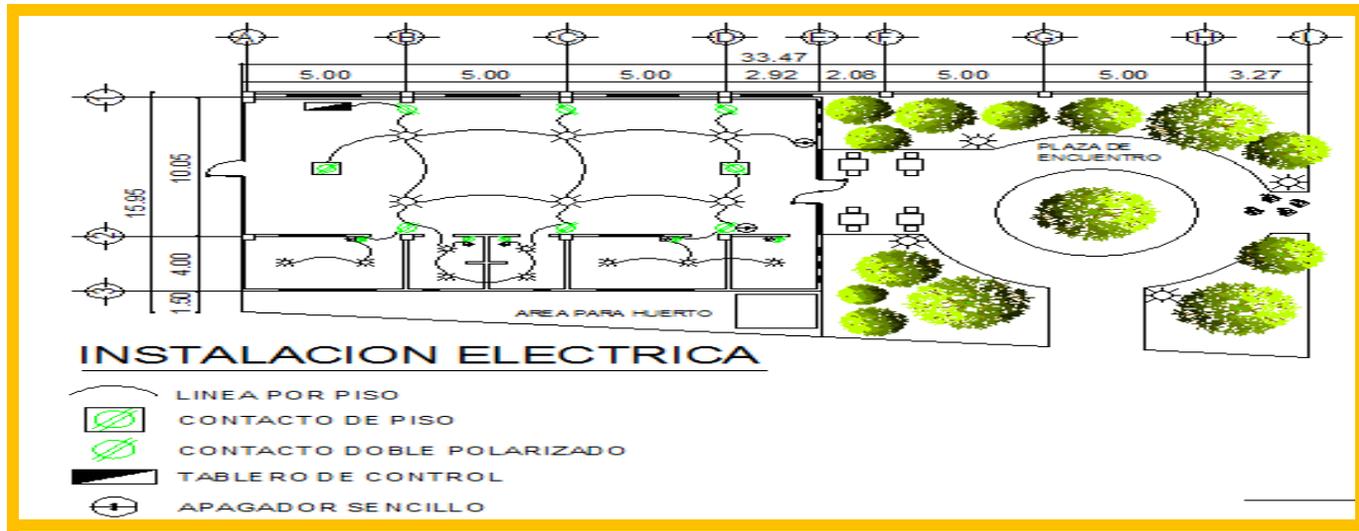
(plano de instalación eléctrica-u.h. Emiliano Zapata)
